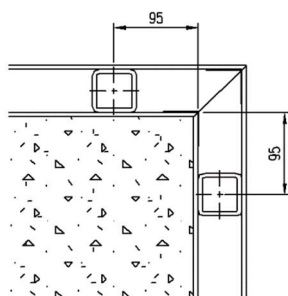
position des montants pour la fixation latérale vue d'en haut
